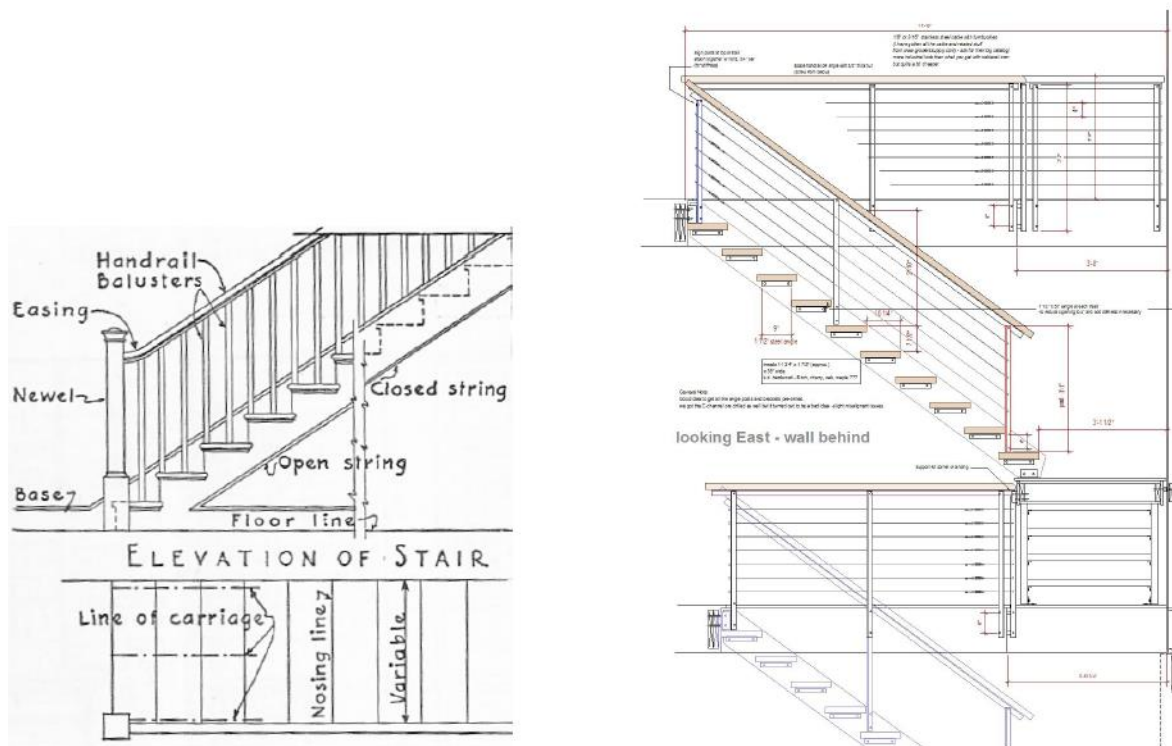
Ejemplo de dibujo a mano alzada (izquierda) y de dibujo utilizando CAD (derecha).
